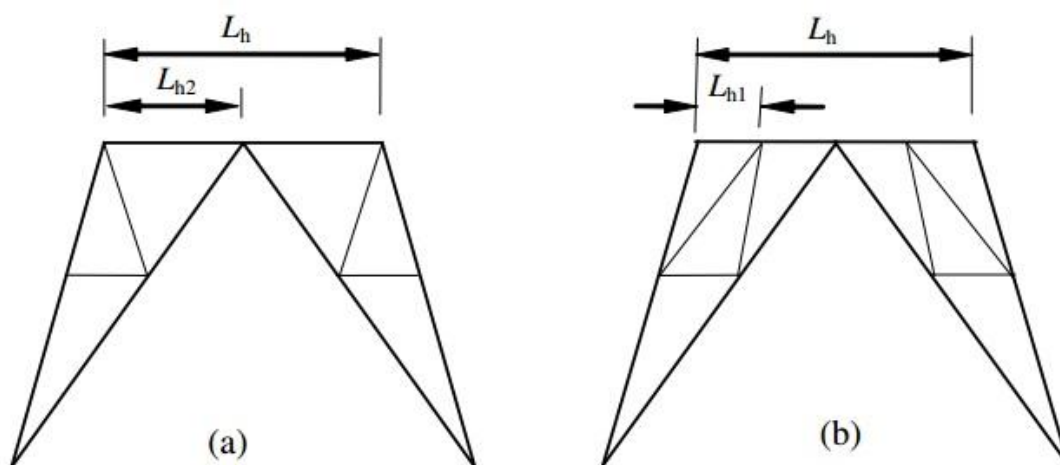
Contraventamento horizontal tipo “K” sem plano de contraventamento
